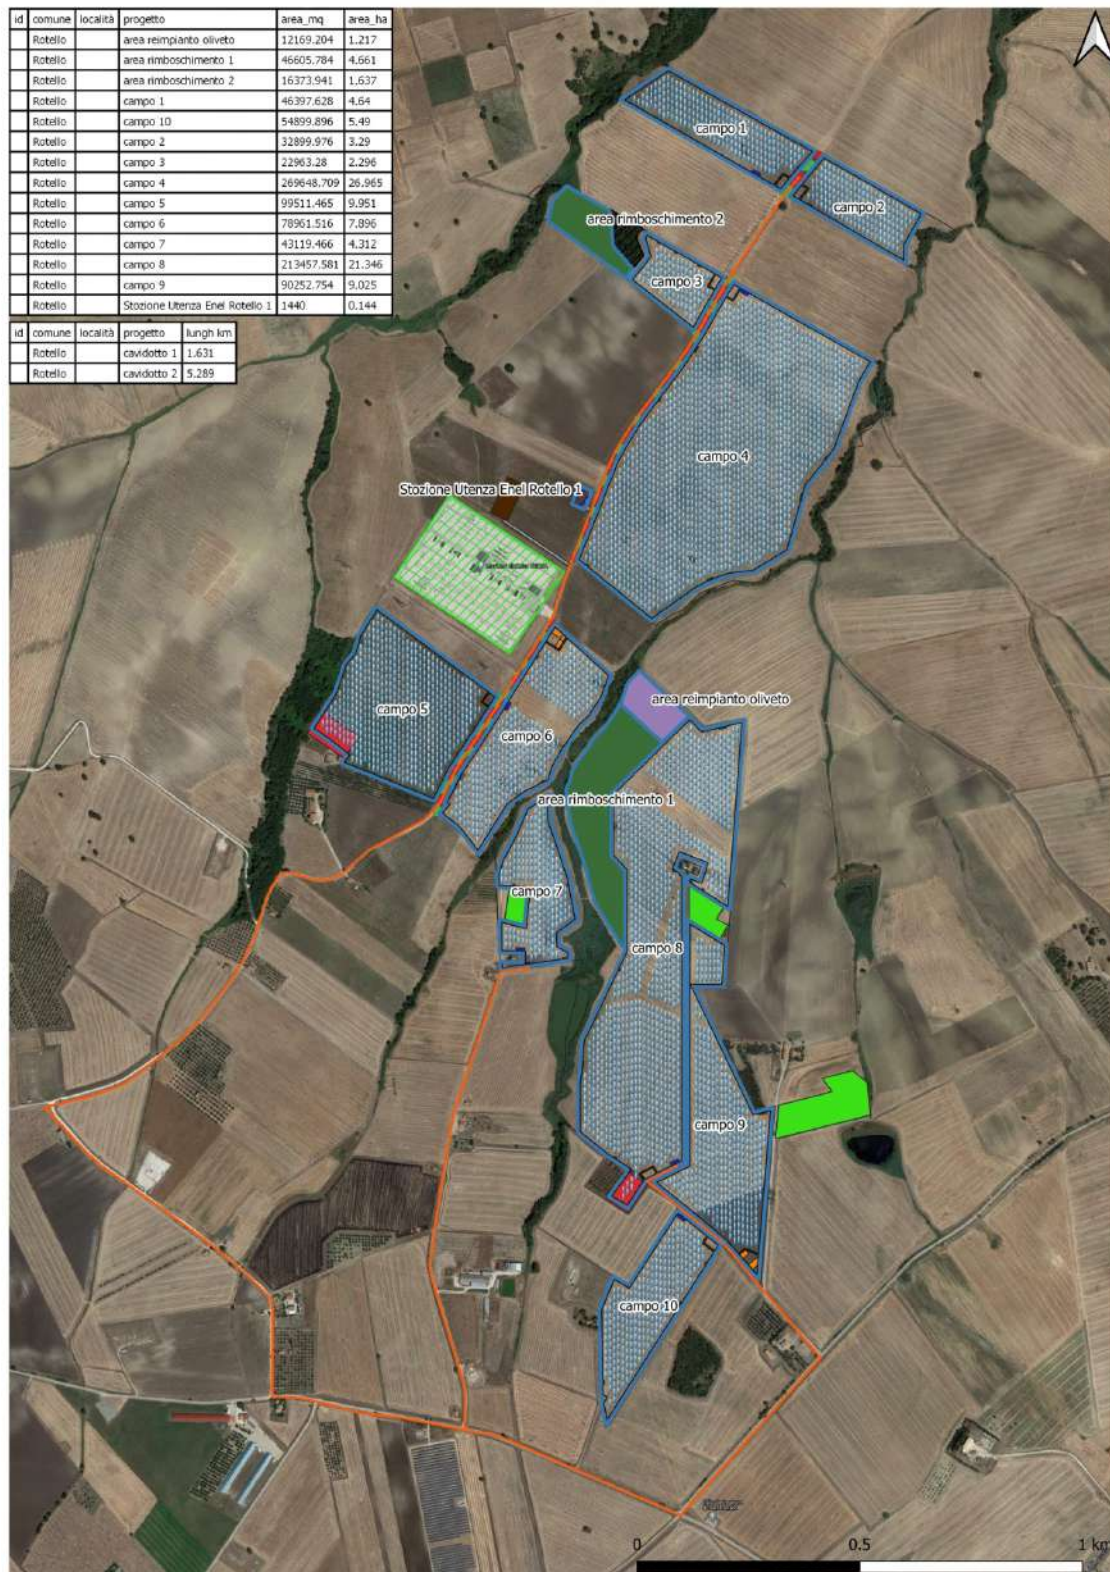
Nell'immagine il layout di progetto su ortofoto
